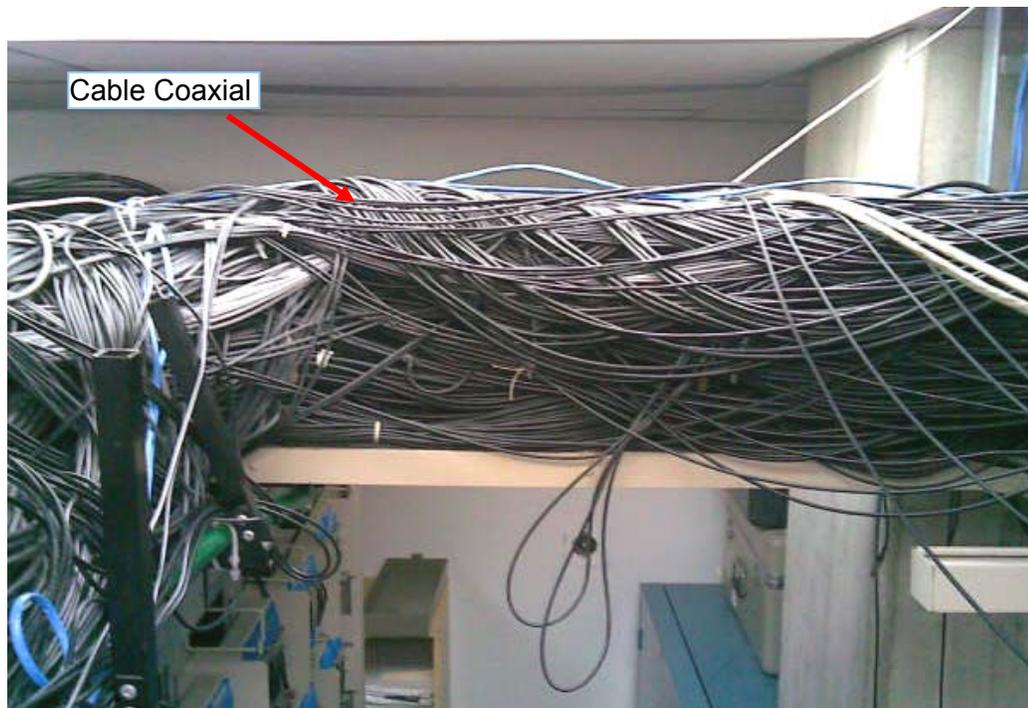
Disposición actual del Sistema de cableado de la Sala Dx. Fuente CANTV
